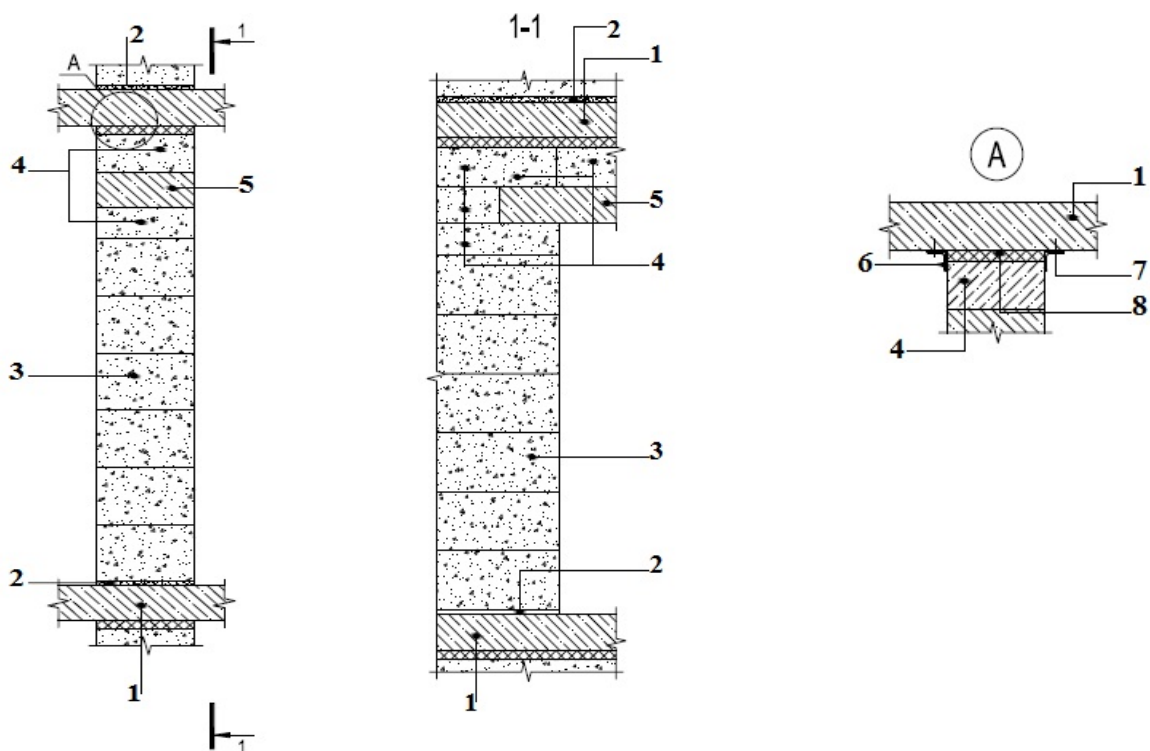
Узлы внутренних стен из газобетонных блоков: 1 — монолитное железобетонное перекрытие; 2 — выравнивающий раствор; 3 — блоки YTONG; 4 — доборные блоки; 5 — перемычка; 6 — металлический уголок (нащельник-фиксатор); 7 — винты-саморезы; 8 — минеральная вата
